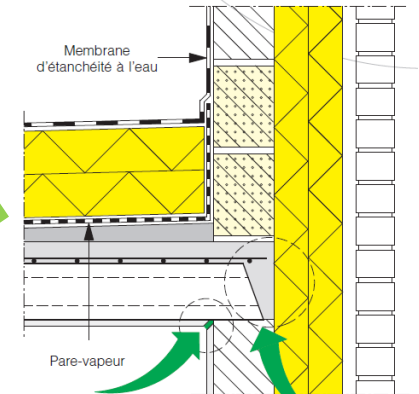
Continuité de l'étanchéité à l'air des planchers de toiture en béton
